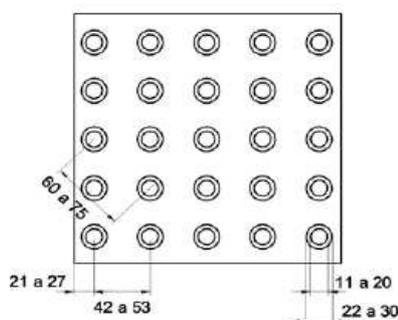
Sinalização tátil de alerta – Modulação do piso
